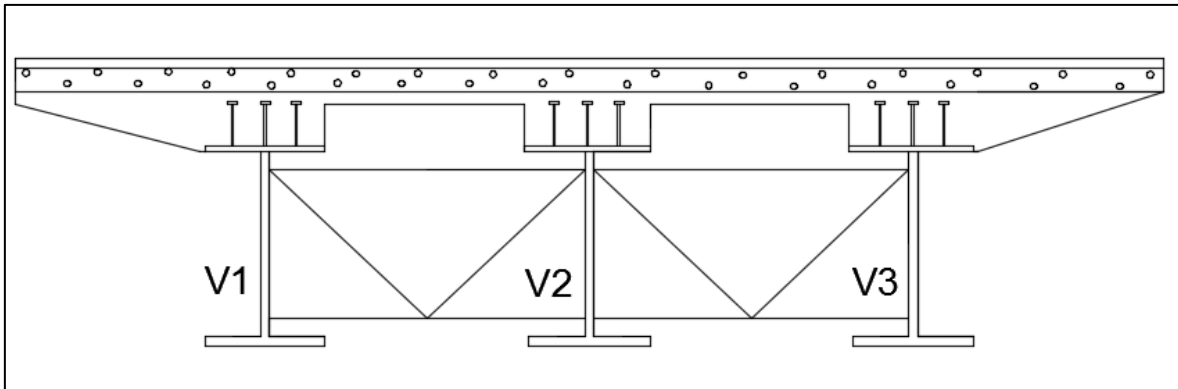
Superestructura conformada por vigas de acero, diafragmas y losa de concreto.
